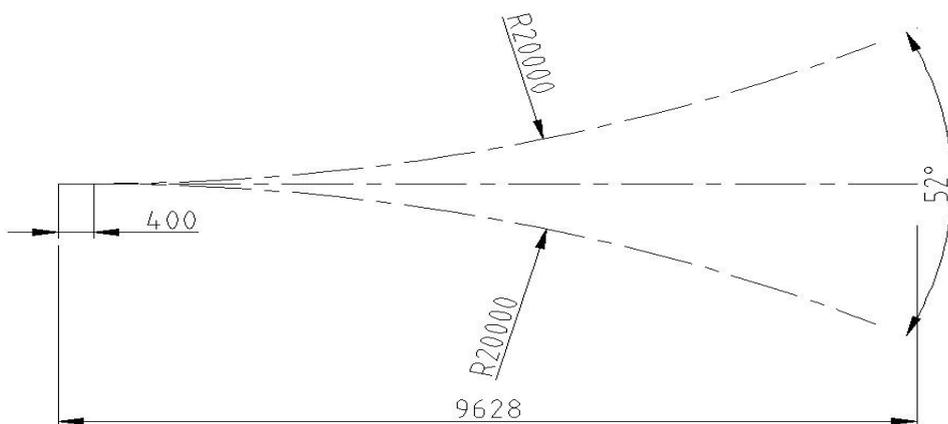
平移型三开道岔线型(尺寸单位: mm)
